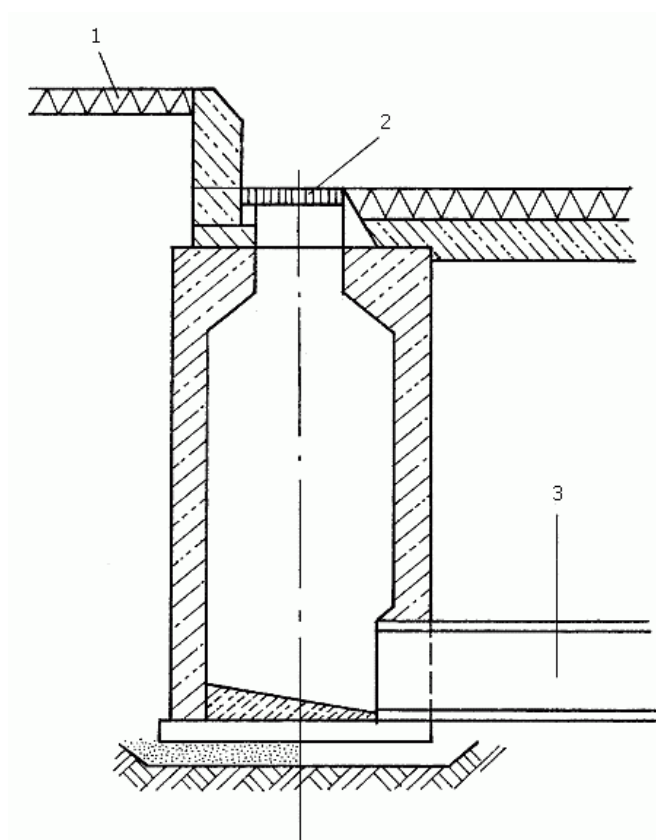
Железобетонный дождеприемник: 1 – тротуар; 2 – решетка; 3 – соединительный трубопровод
